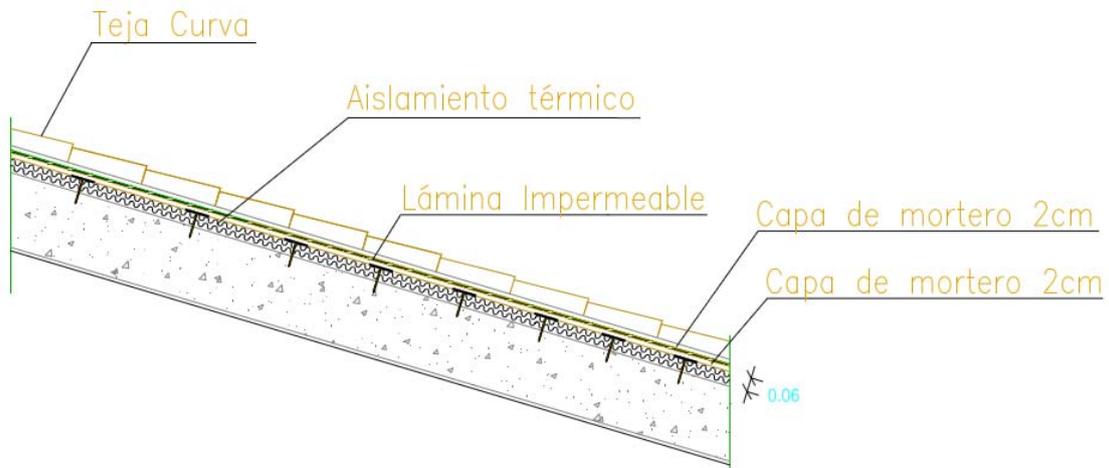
Detalle constructivo de la cubierta con forjado inclinado con la solución propuesta de XPS.
